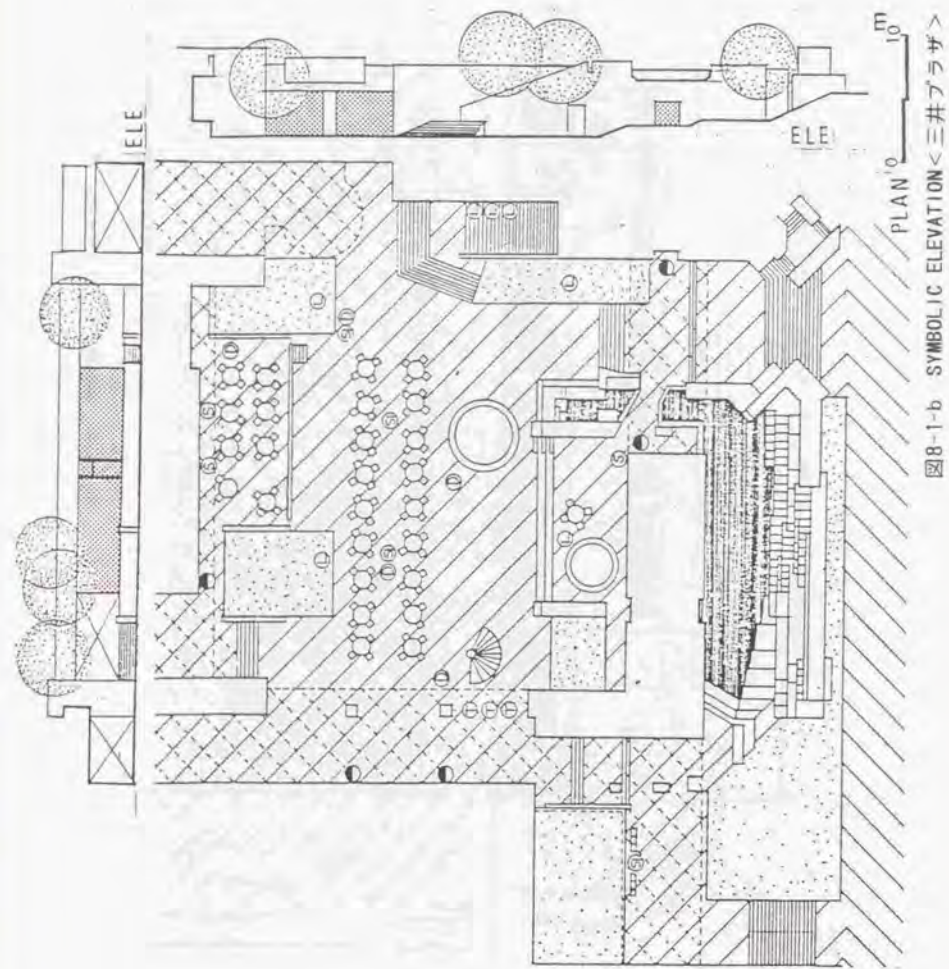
b SYMBOLIC ELEVATION<三井ブラザ>
